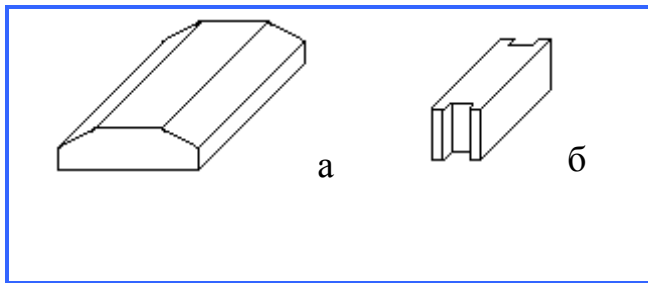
Збірні залізобетонні елементи фундаментів для громадських і житлових будівель: а – блок фундаментний; б – блок стін підвалів
